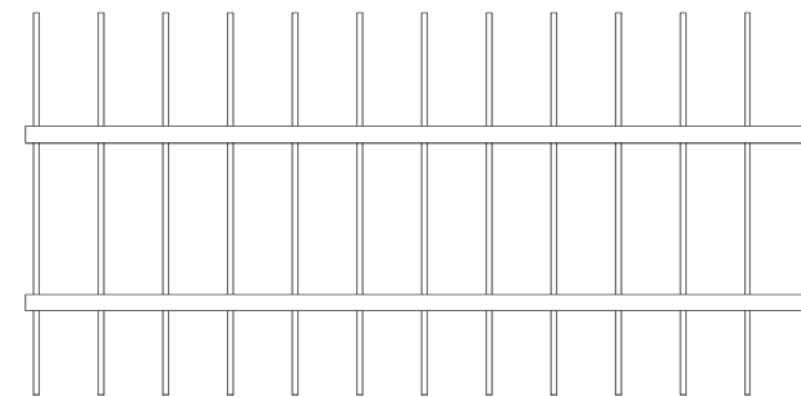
Vista en planta de las vigas longitudinales y transversales. Elaboración propia con AutoCAD.
